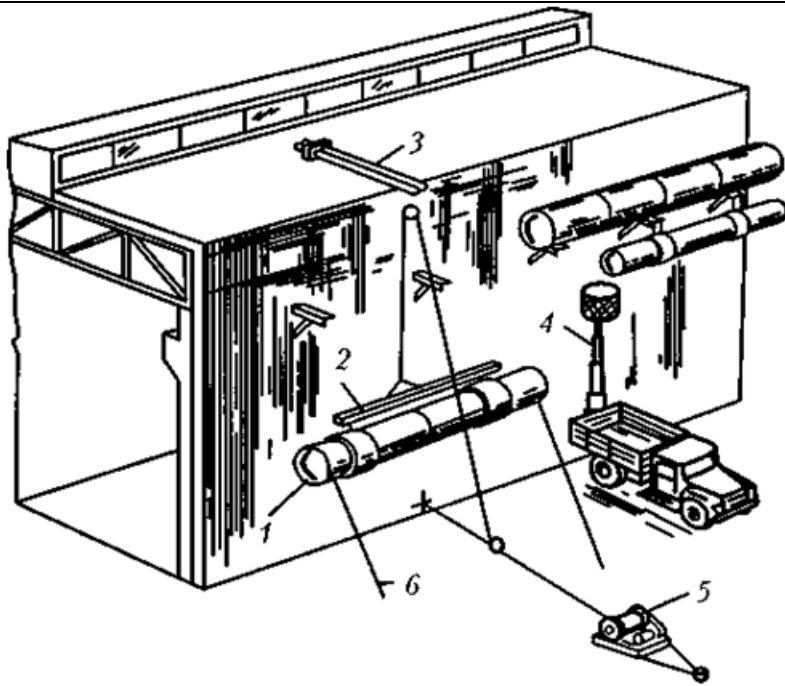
Монтаж горизонтальных воздуховодов по наружным стенам:
